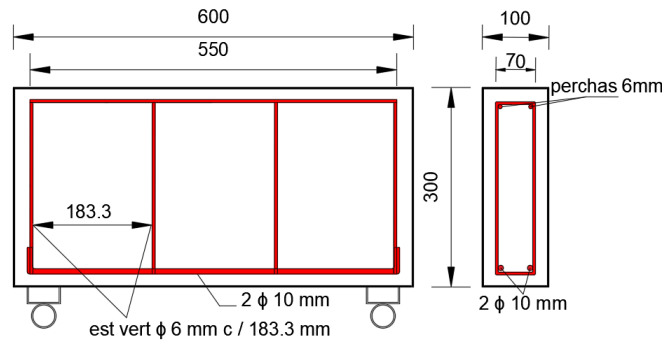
Dimensiones geométricas y detalle de armado de especímenes con armadura a corte reducida.
